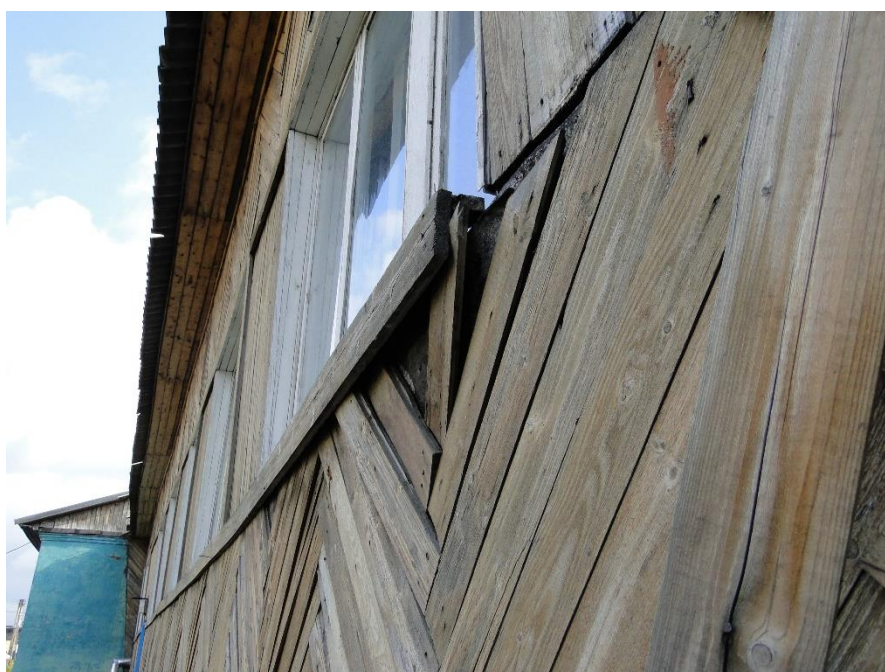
Деформация стены ,нарушение отделки фасада, нарушение геометрии оконных заполнений. Д(3)
